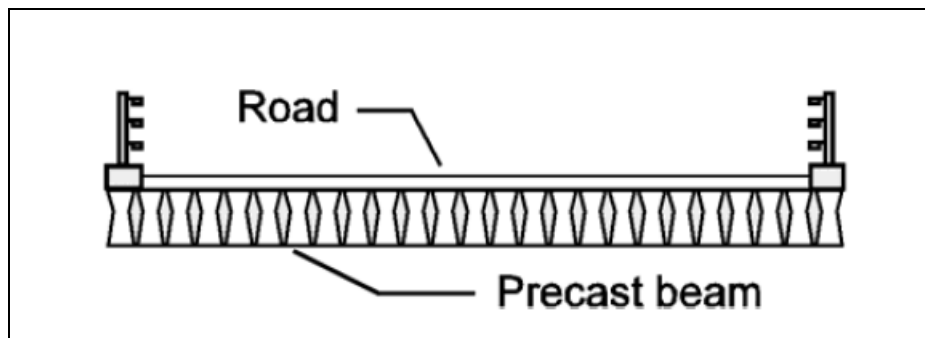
Jenis 3, Prestressed concrete beam & reinforced concrete slab
